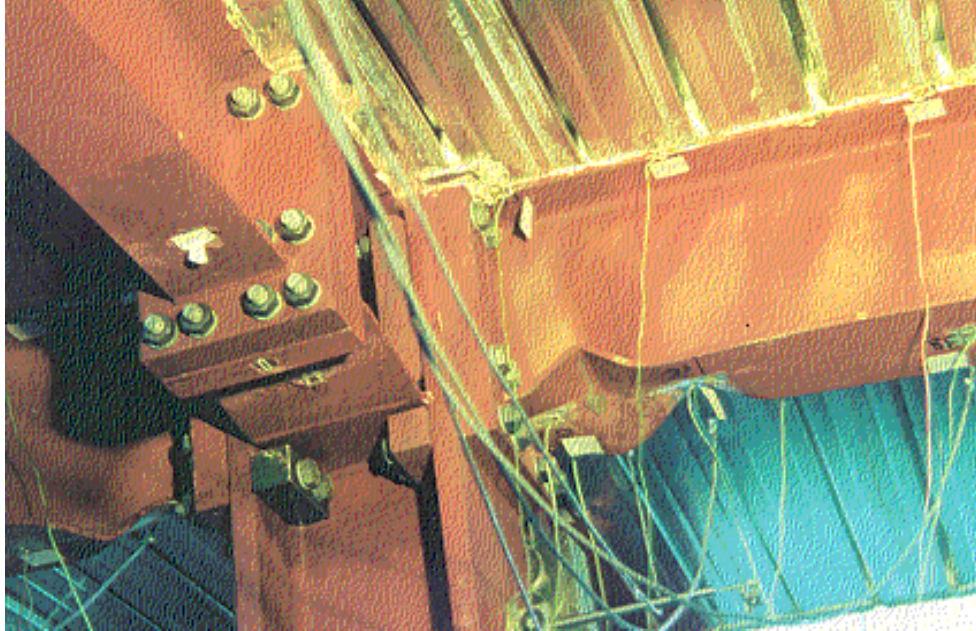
Voilement dans une poutre mixte constitué d'un IPE300 et d'une dalle de 120mm sur bac acier.
